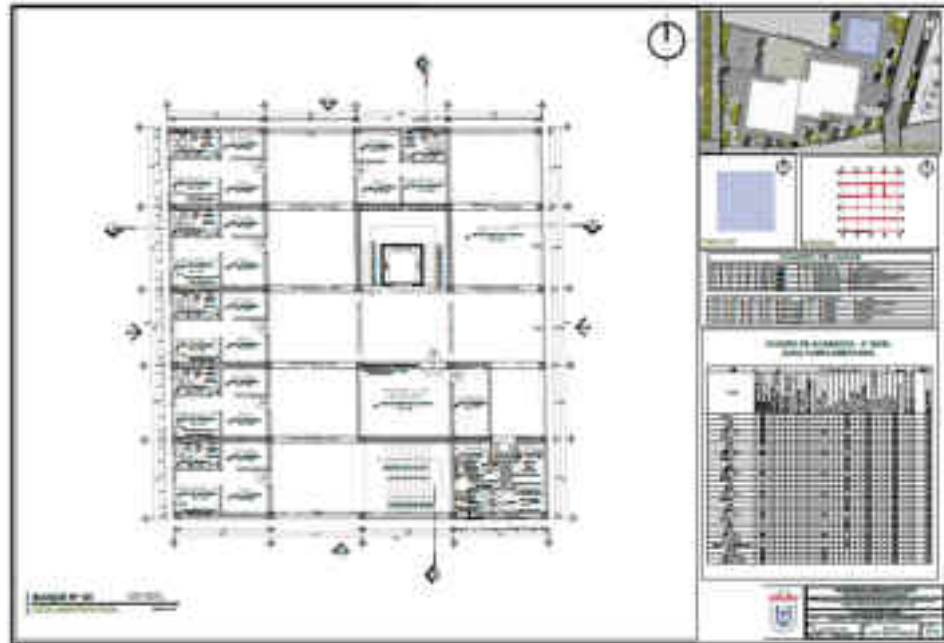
Planimetría del tercer nivel – bloque N° 03
